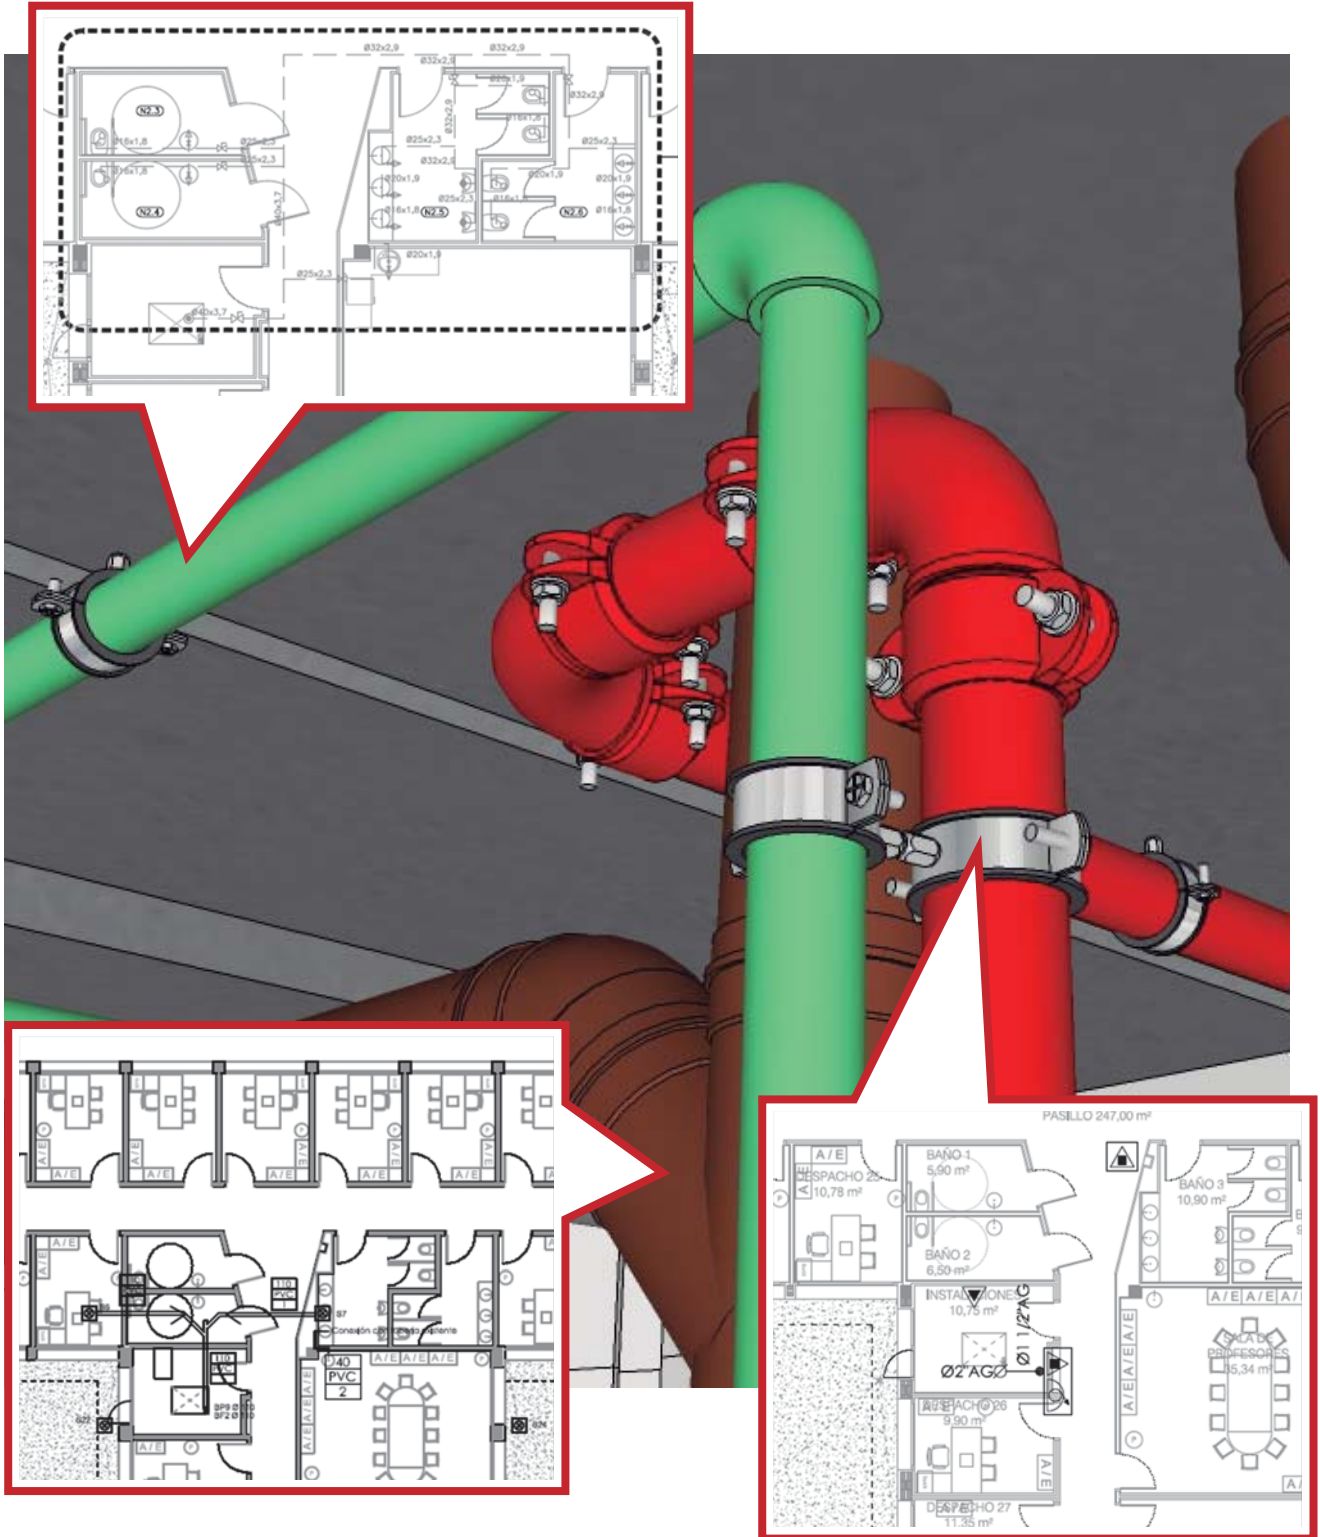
Imagen donde se aprecia el detalle que alcanza el modelado 3D. Se puede ver conducciones del patinillo central en la planta segunda
